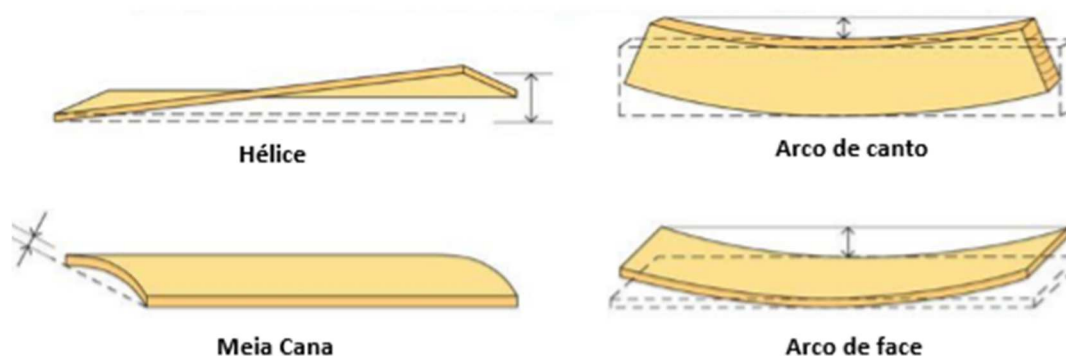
Principais tipos de empenos da madeira (Hilário, 2003: 9)
